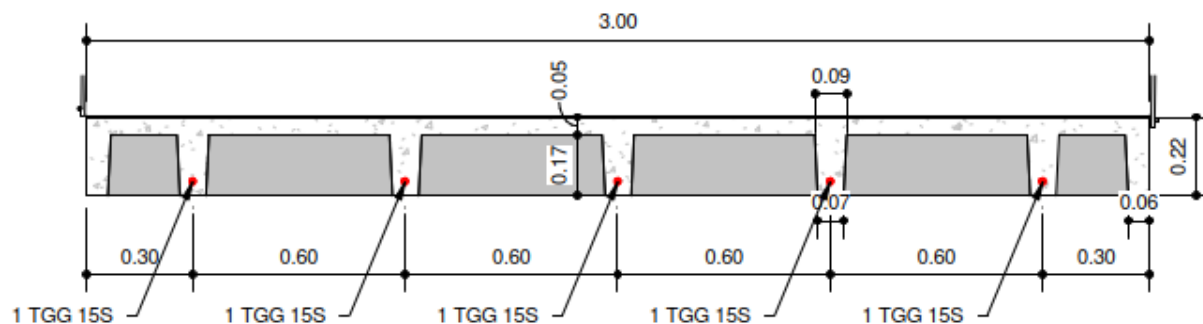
Coupe transversale d'un platelage de type 2 (à la clé)
